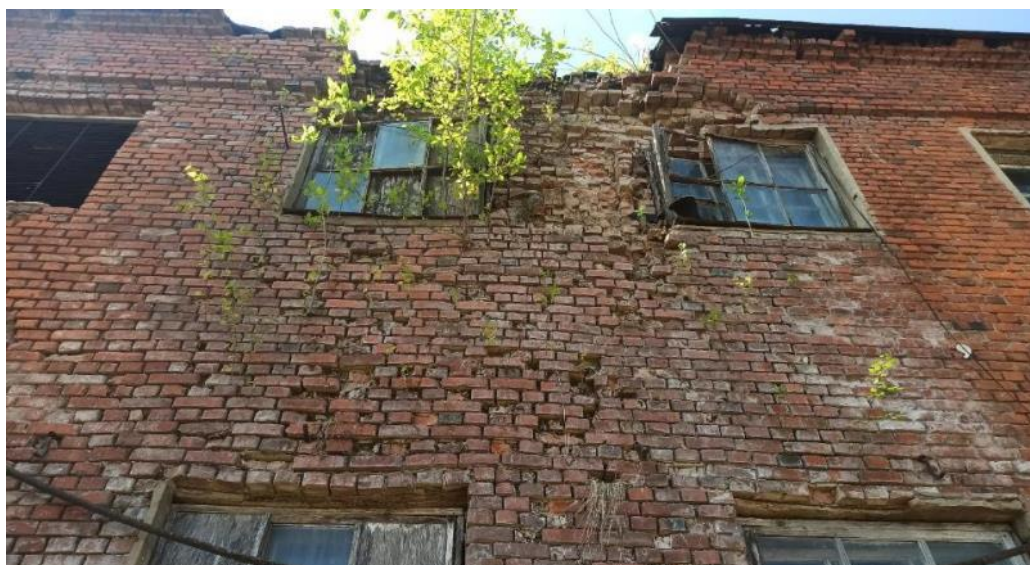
Крупный план на аварийный участок стены на северо-восточном фасаде
